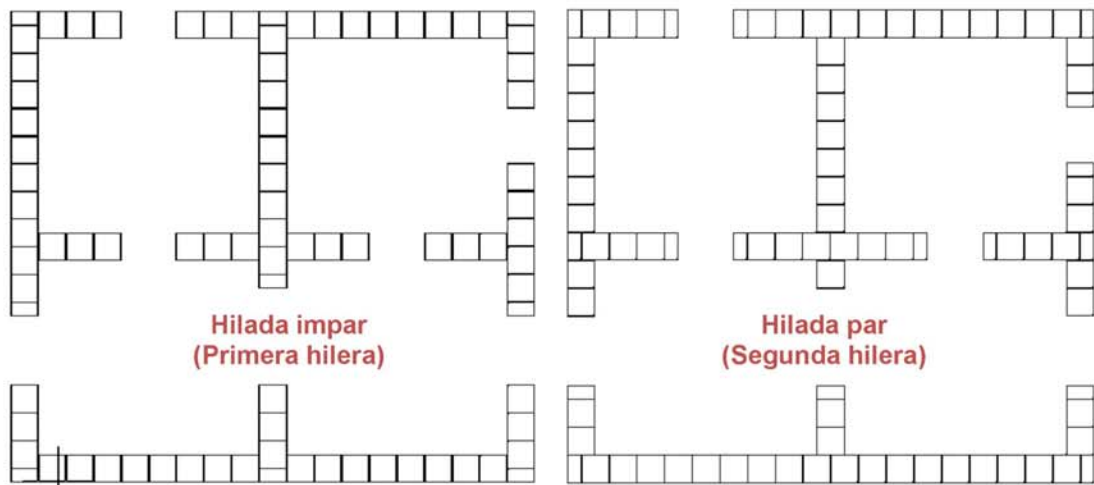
Emplantillado de hilada impar (izquierda) y par (derecha)
